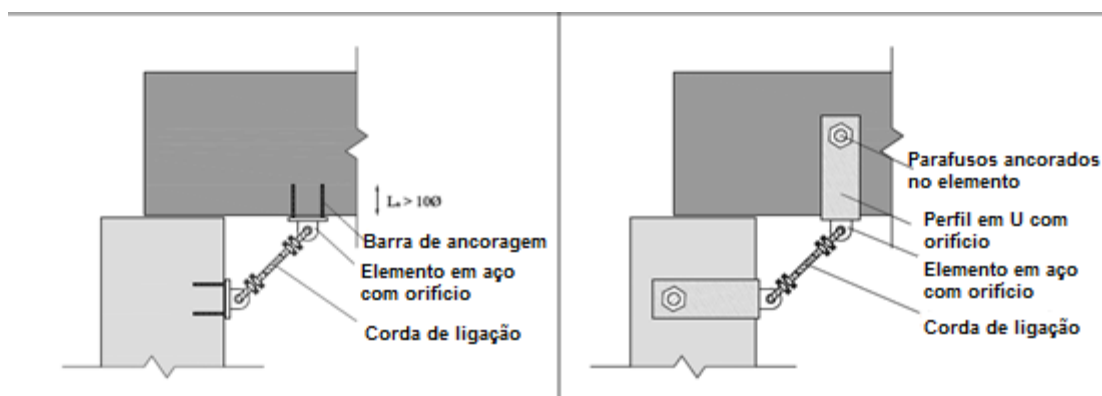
Exemplos de Intervenção para a ligação entre viga e pilar [1]
